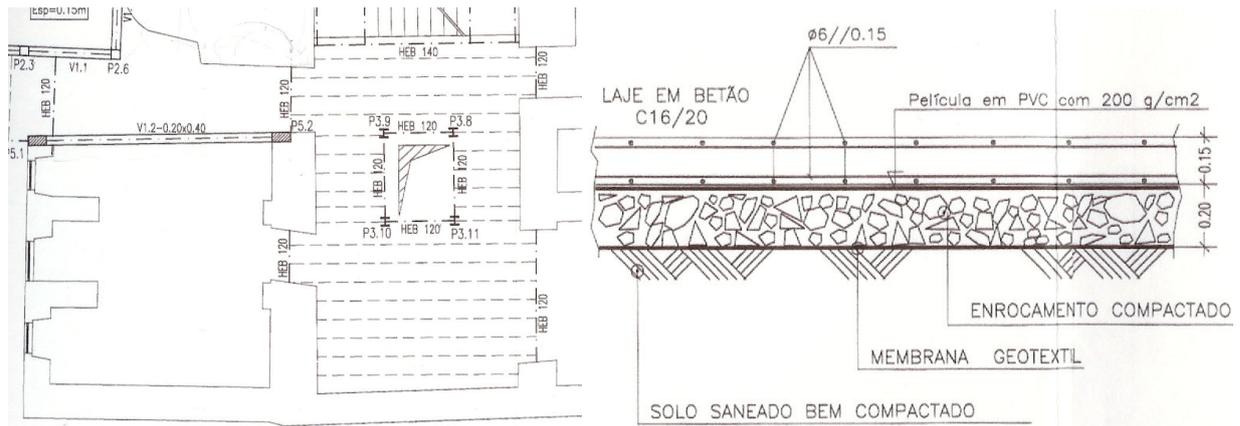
Planta Estrutural do tecto do piso 0 e corte da laje térrea
